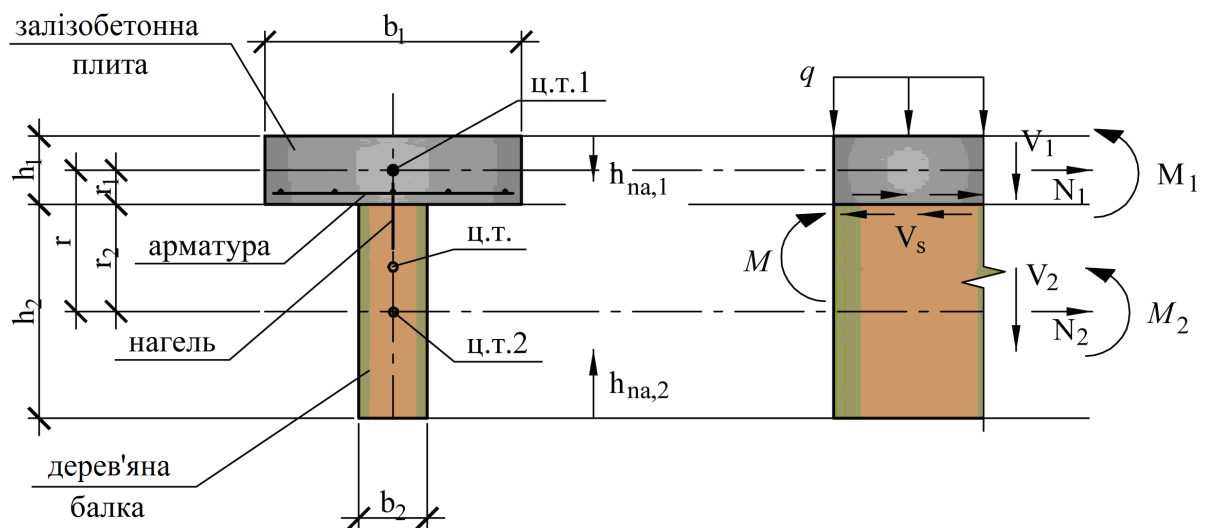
Розрахункова схема і основні параметри поперечного перерізу деревозалізобетонного згинального елемента: h_1 , h_2 , b_1 , b_2 – висота і ширина залізобетонної плити і дерев'яної балки, відповідно; r – відстань між центрами ваги бетонної плити і дерев'яної балки; M_1 , M_2 – згинальні моменти; V_1 , V_2 – поперечна сила; V_s – розподілена по довжині зсувна сила на кордоні контакту; N_1 , N_2 – поздовжня сила в бетонній плиті і дерев'яній балці
